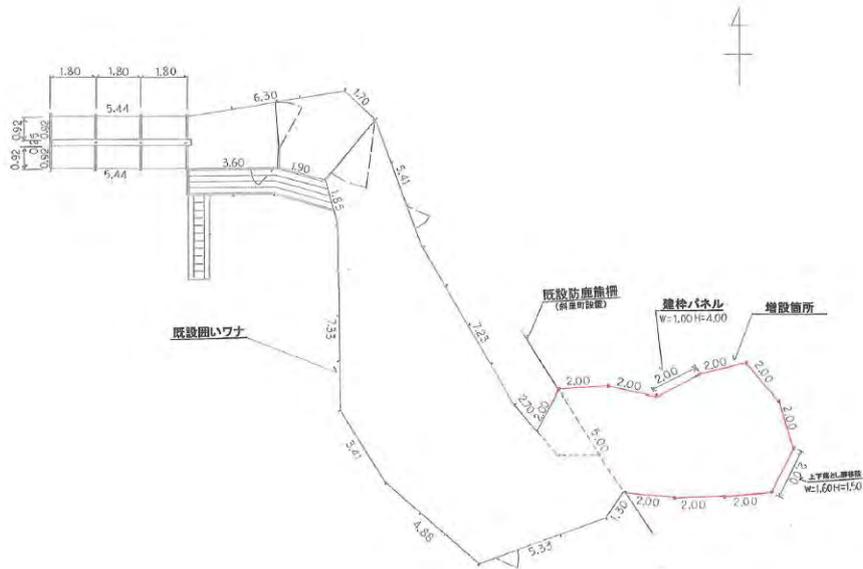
本事業で設置した囲いワナの平面図 (赤線が増設部).
